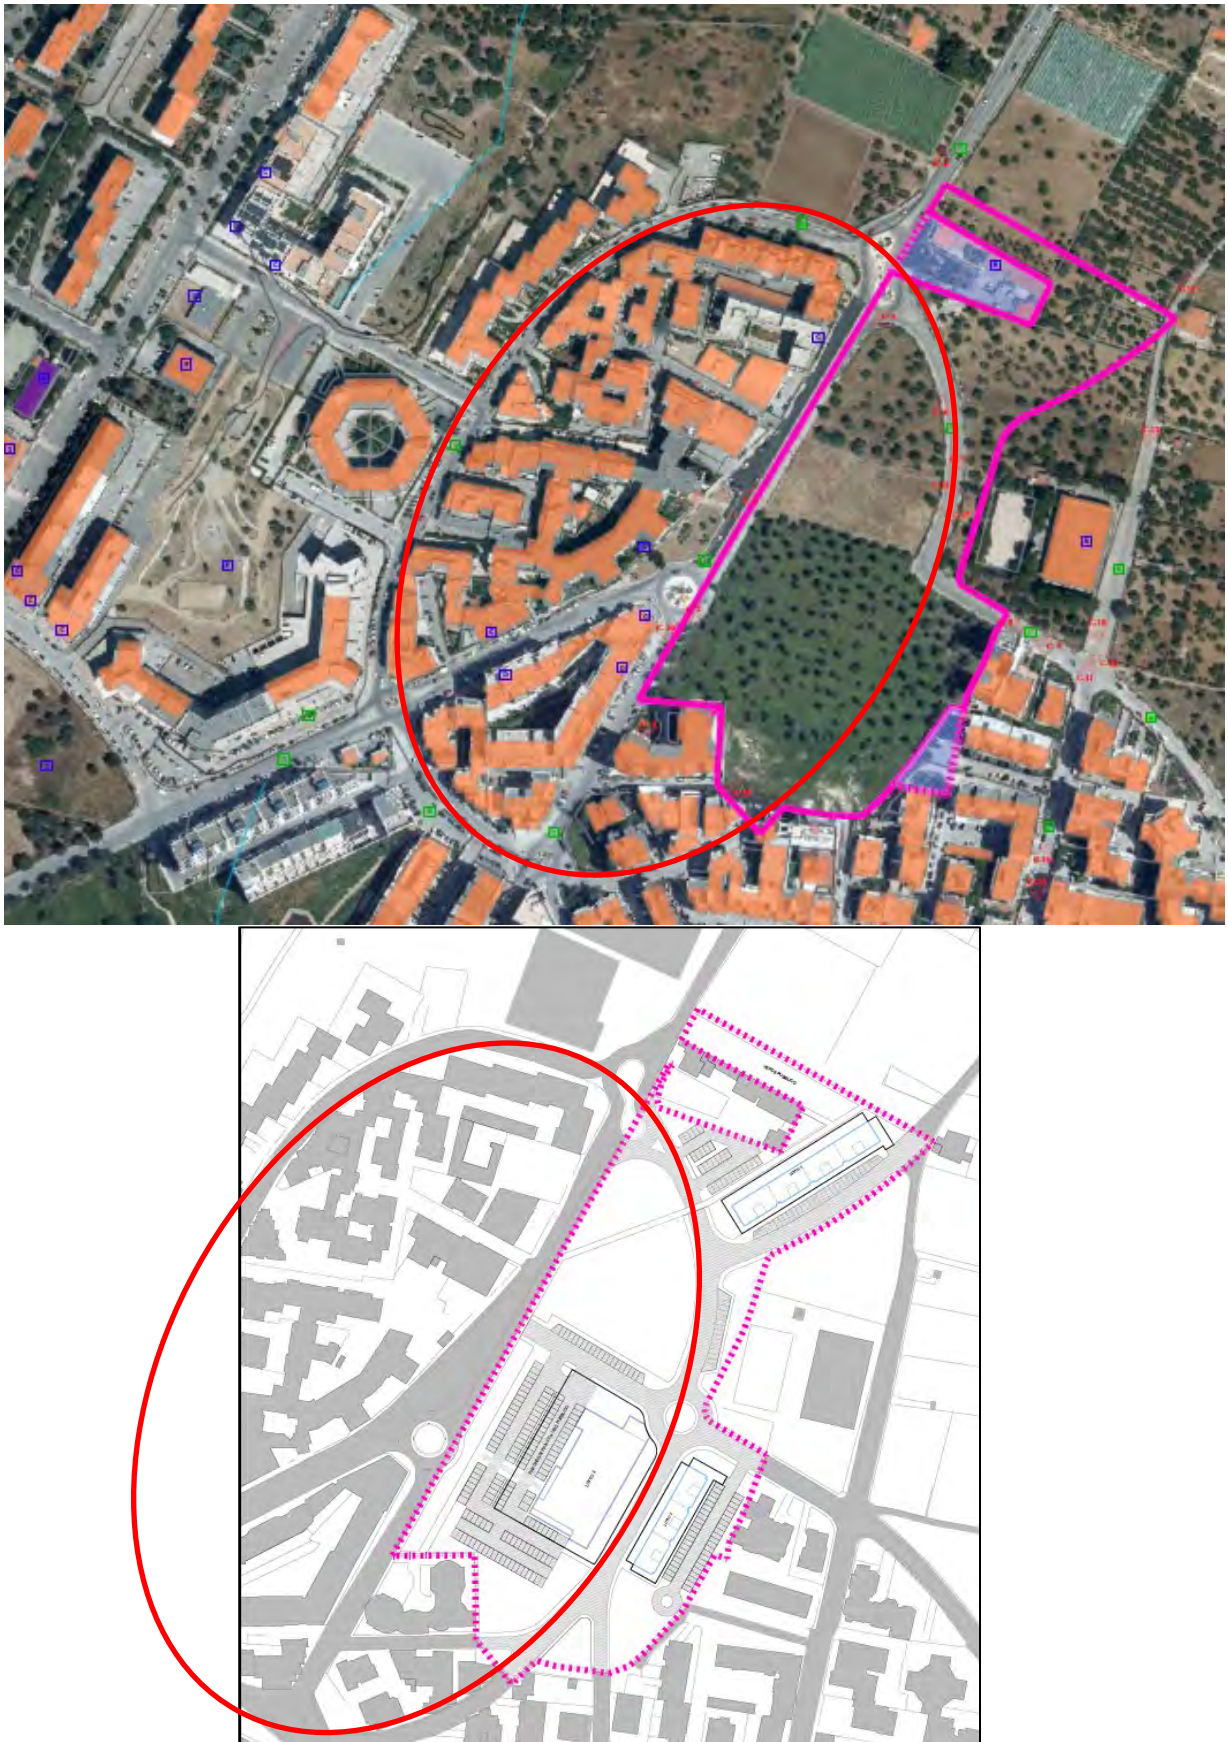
/b - Assetto della viabilità di PRG (chiusura dell'assetto viario ellittico) esistente e di progetto
